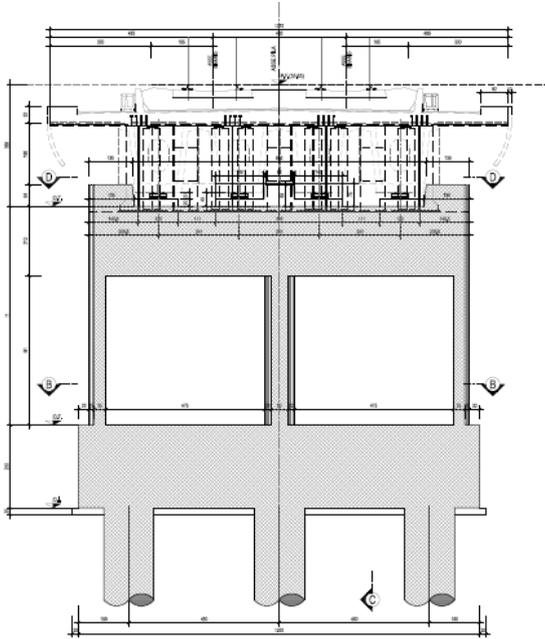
Sezione in direzione longitudinale e trasversale pila di transizione
